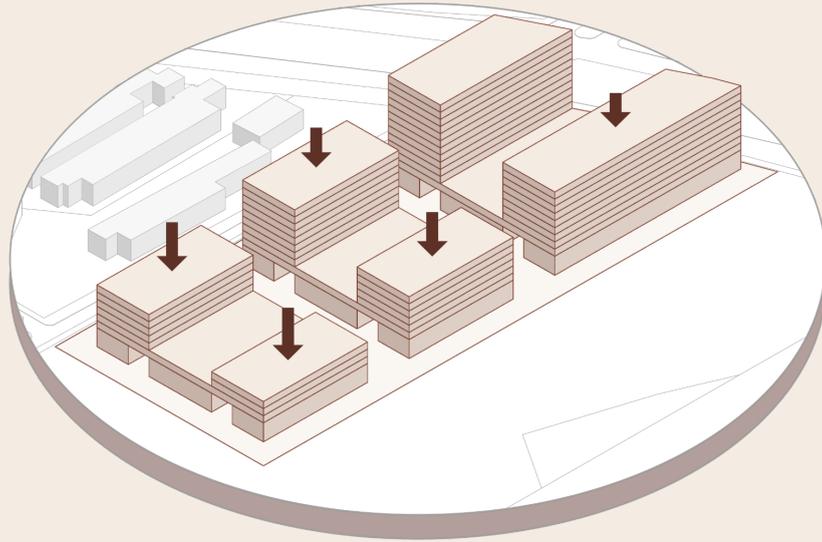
Quinta estrategia de intervención del proyecto (Fuente elaboración propia)
